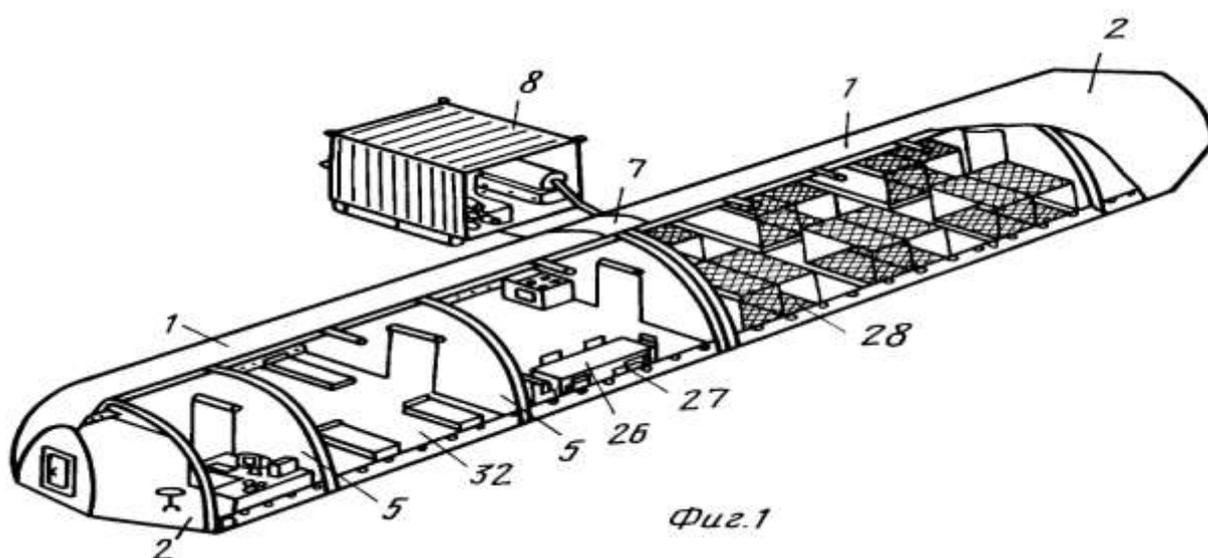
Конструкция пневмокаркасного быстровозводимого сооружения
